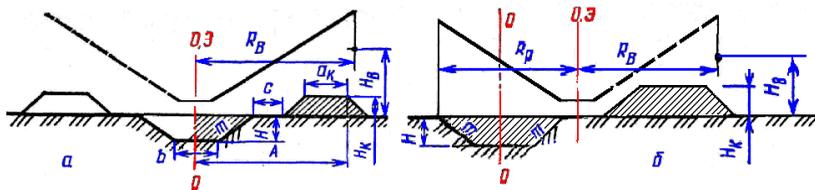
Способы разработки грунта: а – продольный; б – поперечный
